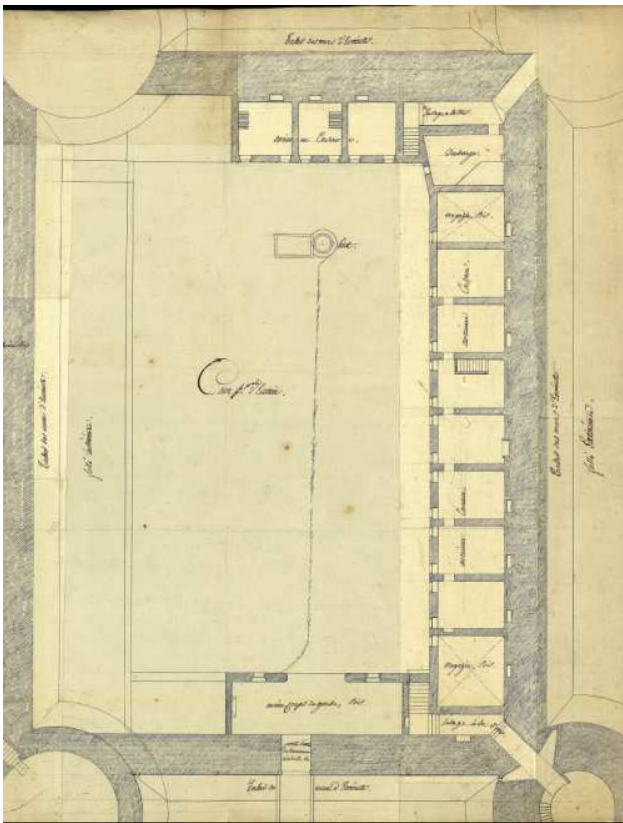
rilievo Maguin,1807-stralcio 1° cortile piano primo
